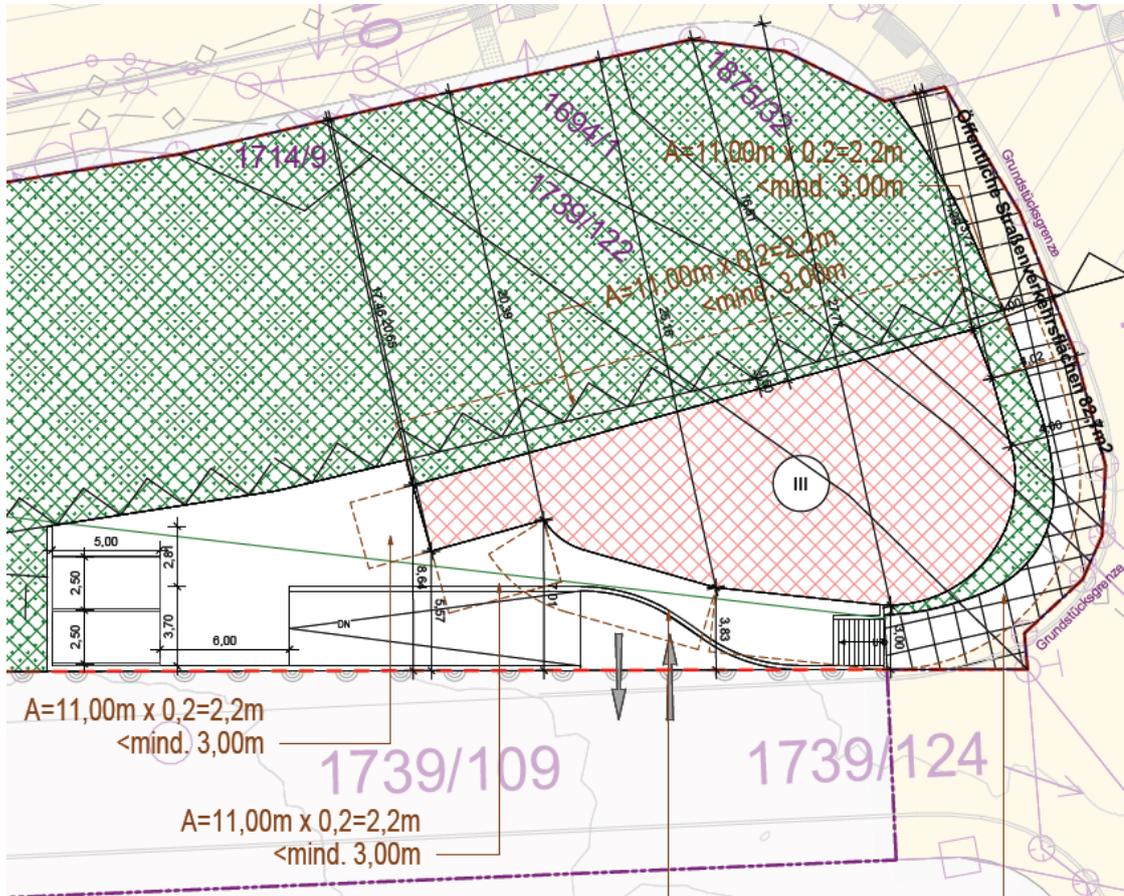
Ausschnitt Abstandsflächenplan, Papadopoulos Associates GmbH vom 22.03.2024, bearbeitet, aus [24]
